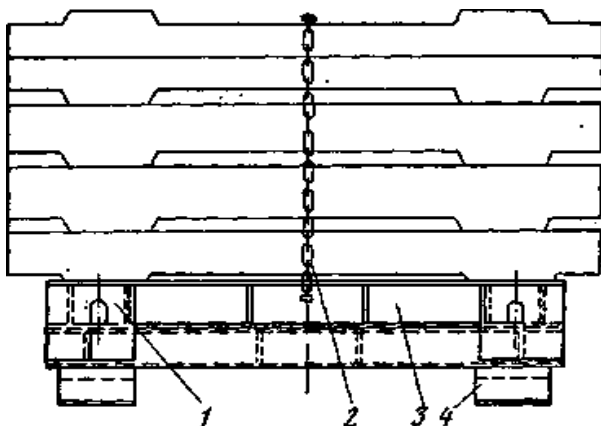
Поддон для перевозки железобетонных шпал, стоек
